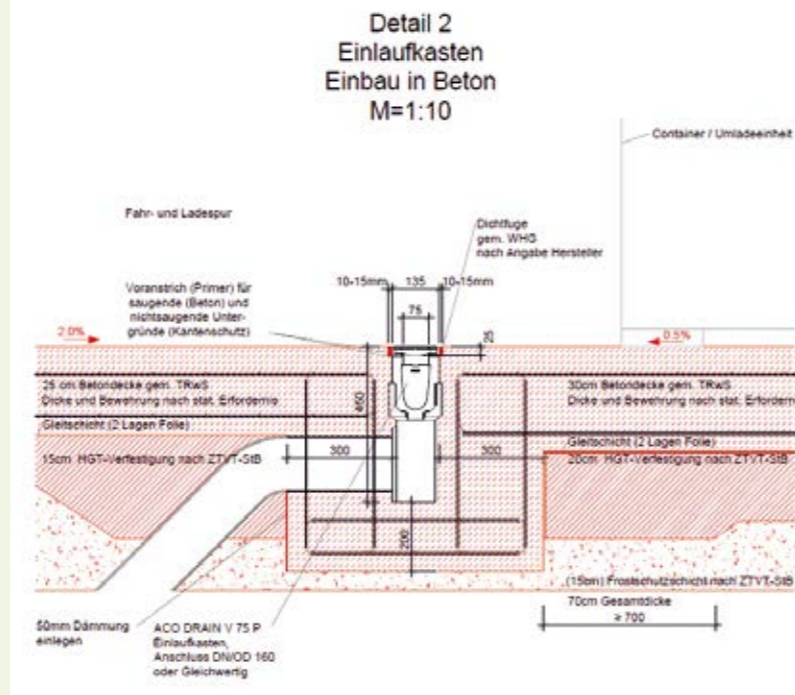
Ausführungsbeispiel der Entwässerung einer WHG-Fläche
